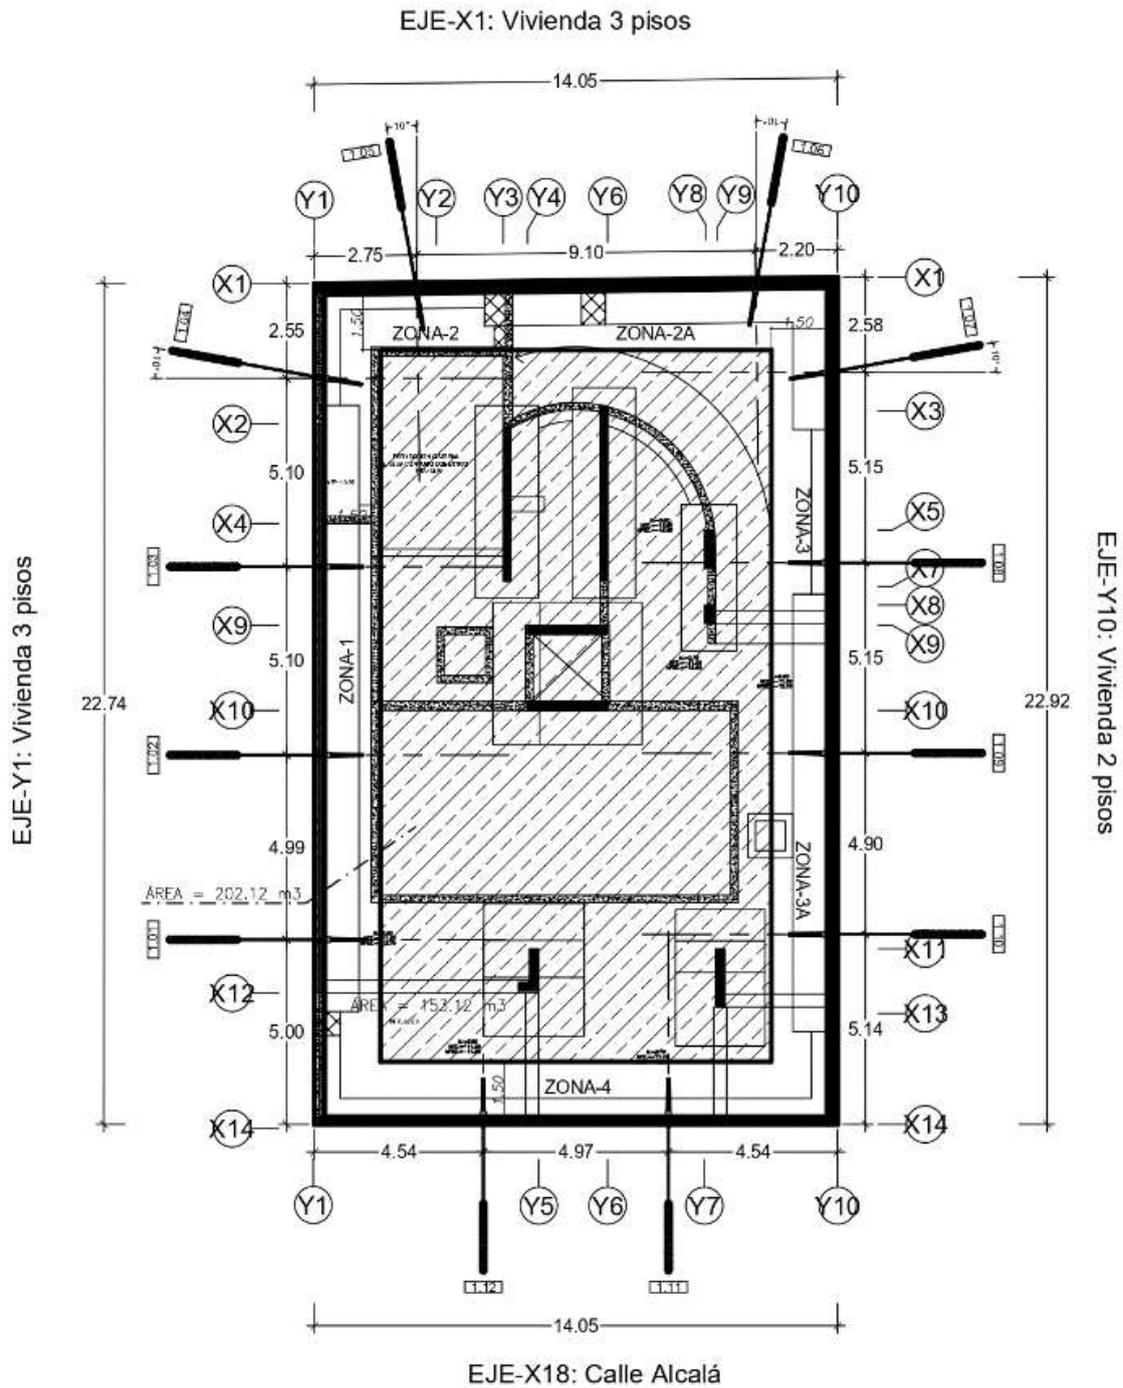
Plano de muro pantalla del segundo anillo incluyendo el área de la excavación masiva.
